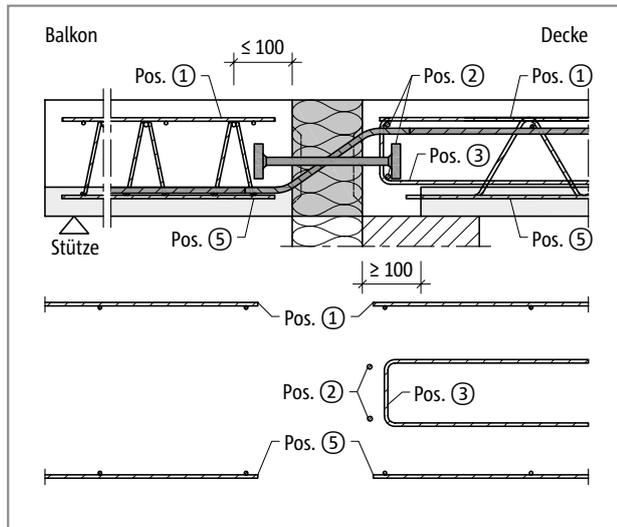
Schöck Isokorb® Typ QPXT: Bauseitige Bewehrung
